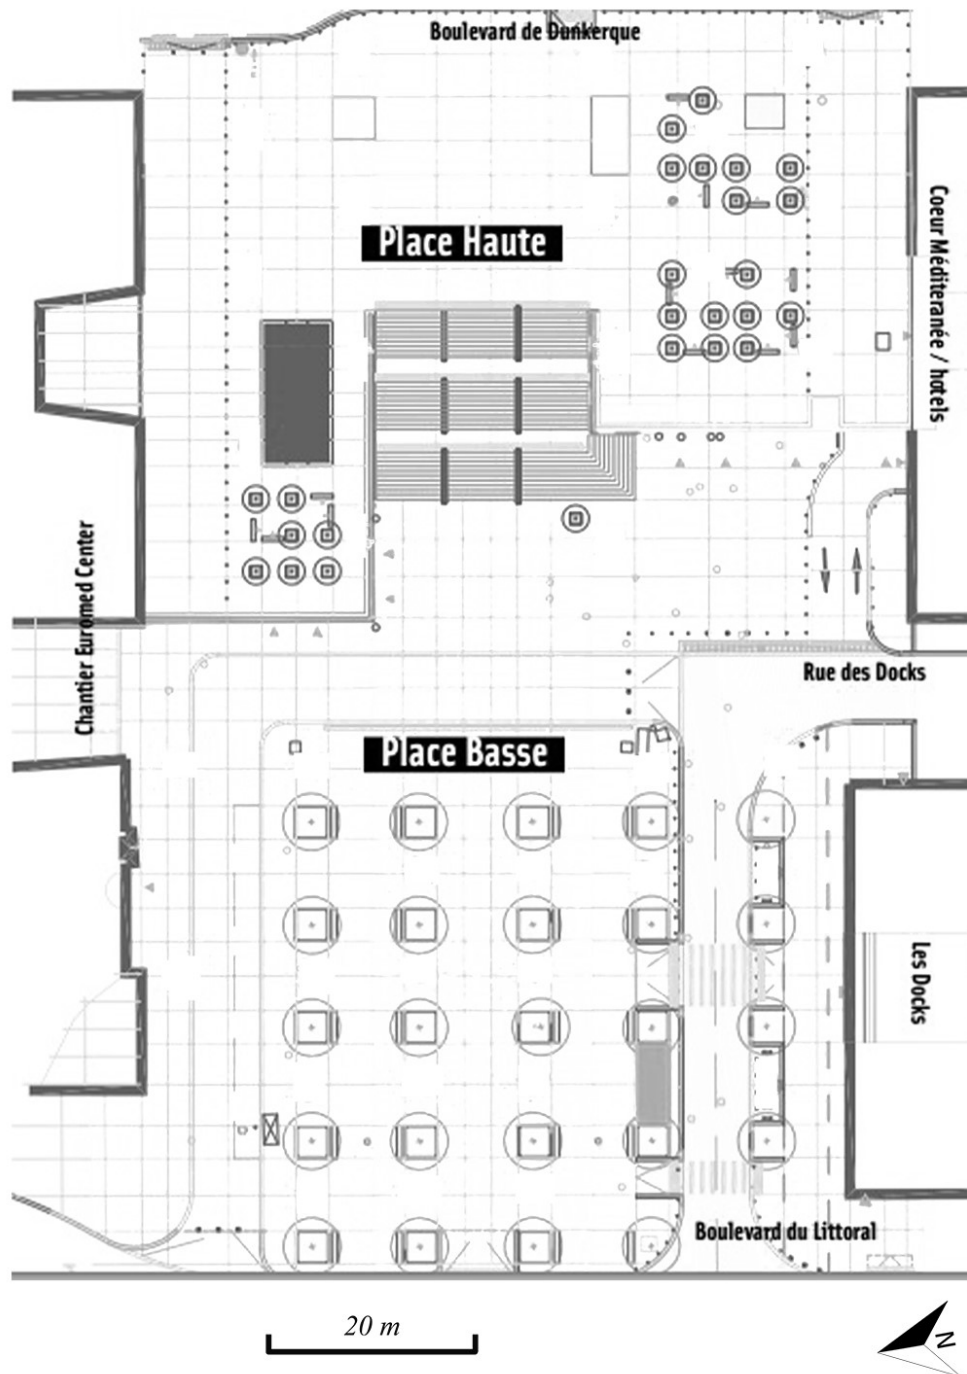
Plan de la place Henri Verneuil par les concepteurs
